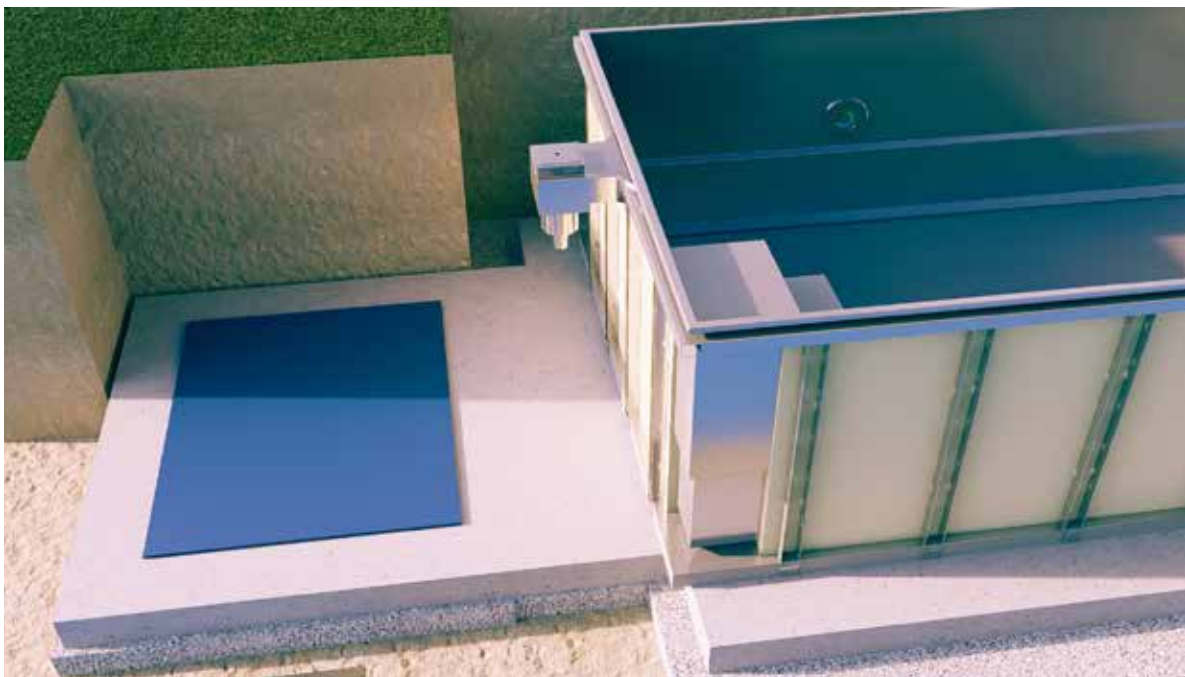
Aushub mit dem Platz für Schacht/Ausgleichsbehälter - Gesamtblick
